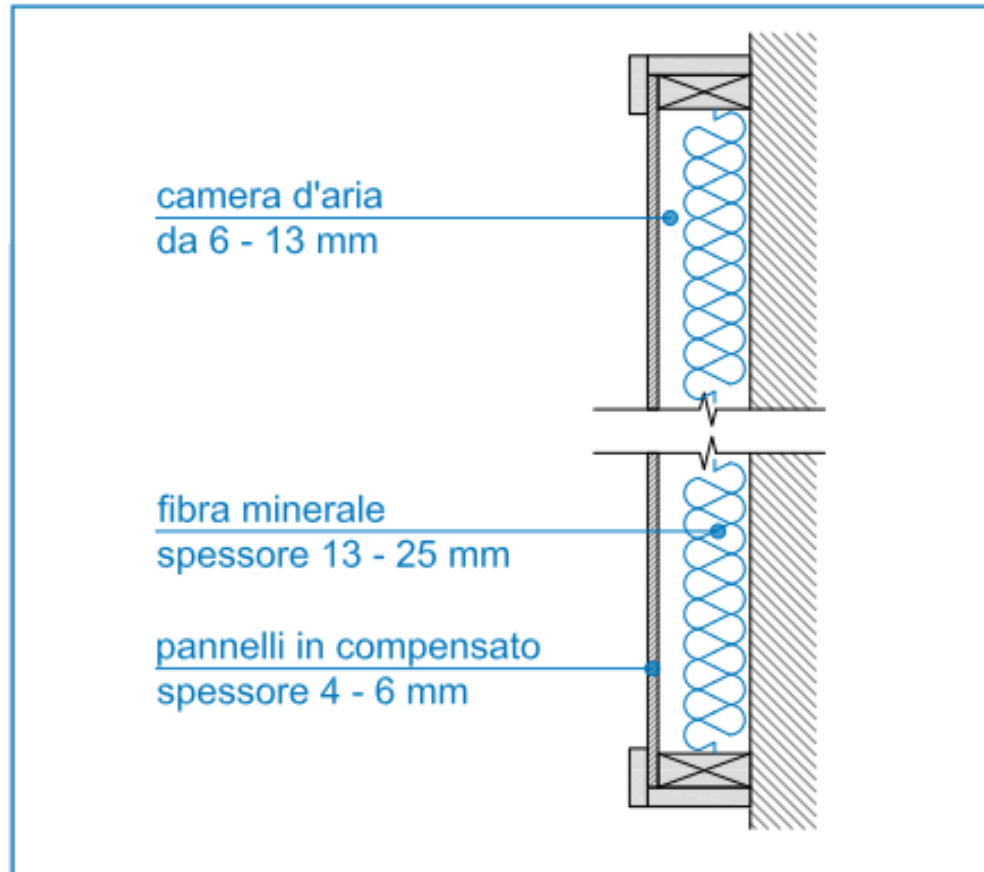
Tipico pannello vibrante montato a parete [5].
